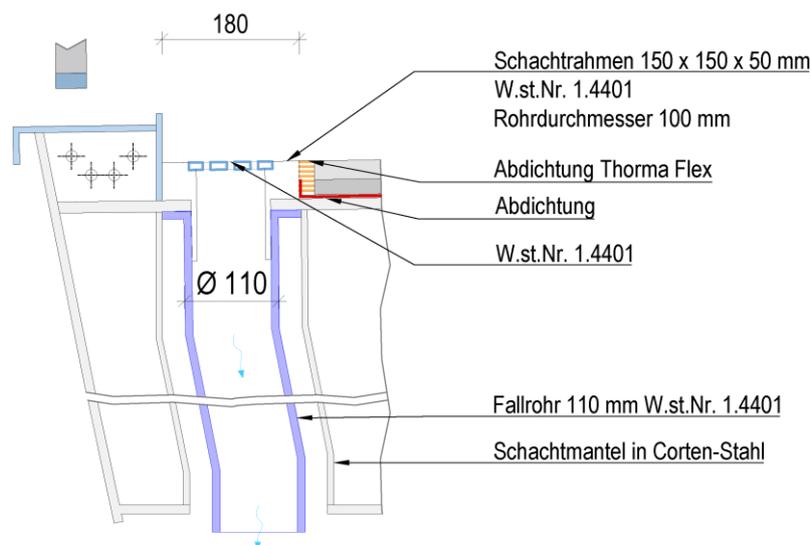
FVV Brücke: Entwässerung Fallrohr Schnitt
